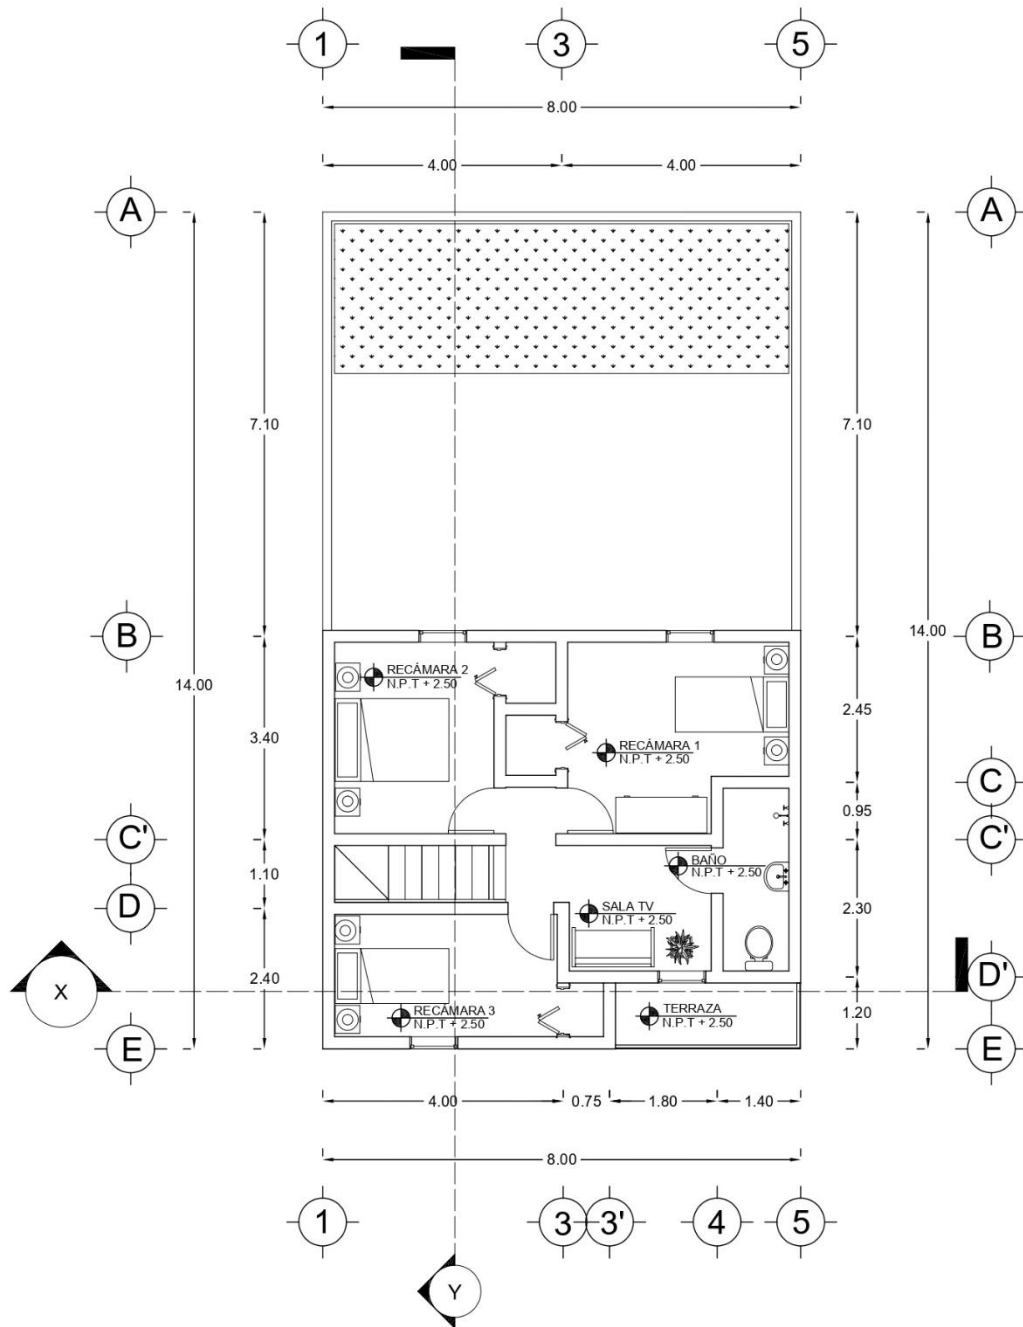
Planta baja. Tercera etapa de diseño.
